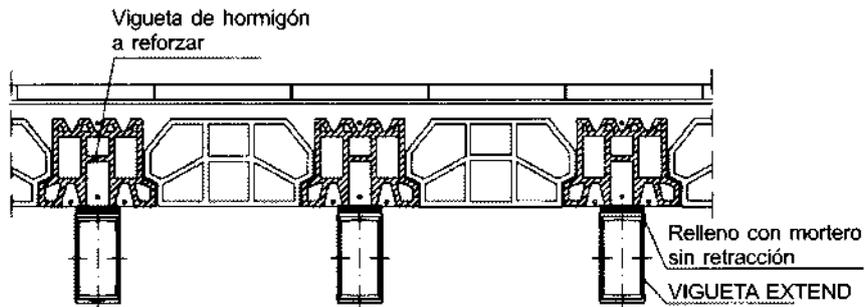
Sección refuerzo. Vigueta de cerámica armada.
